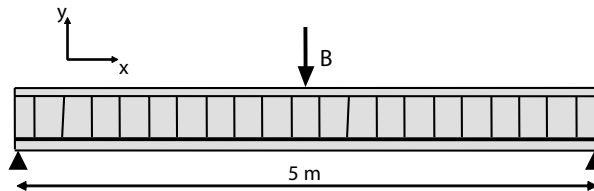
Flexion trois points d'une poutre en béton armé.
